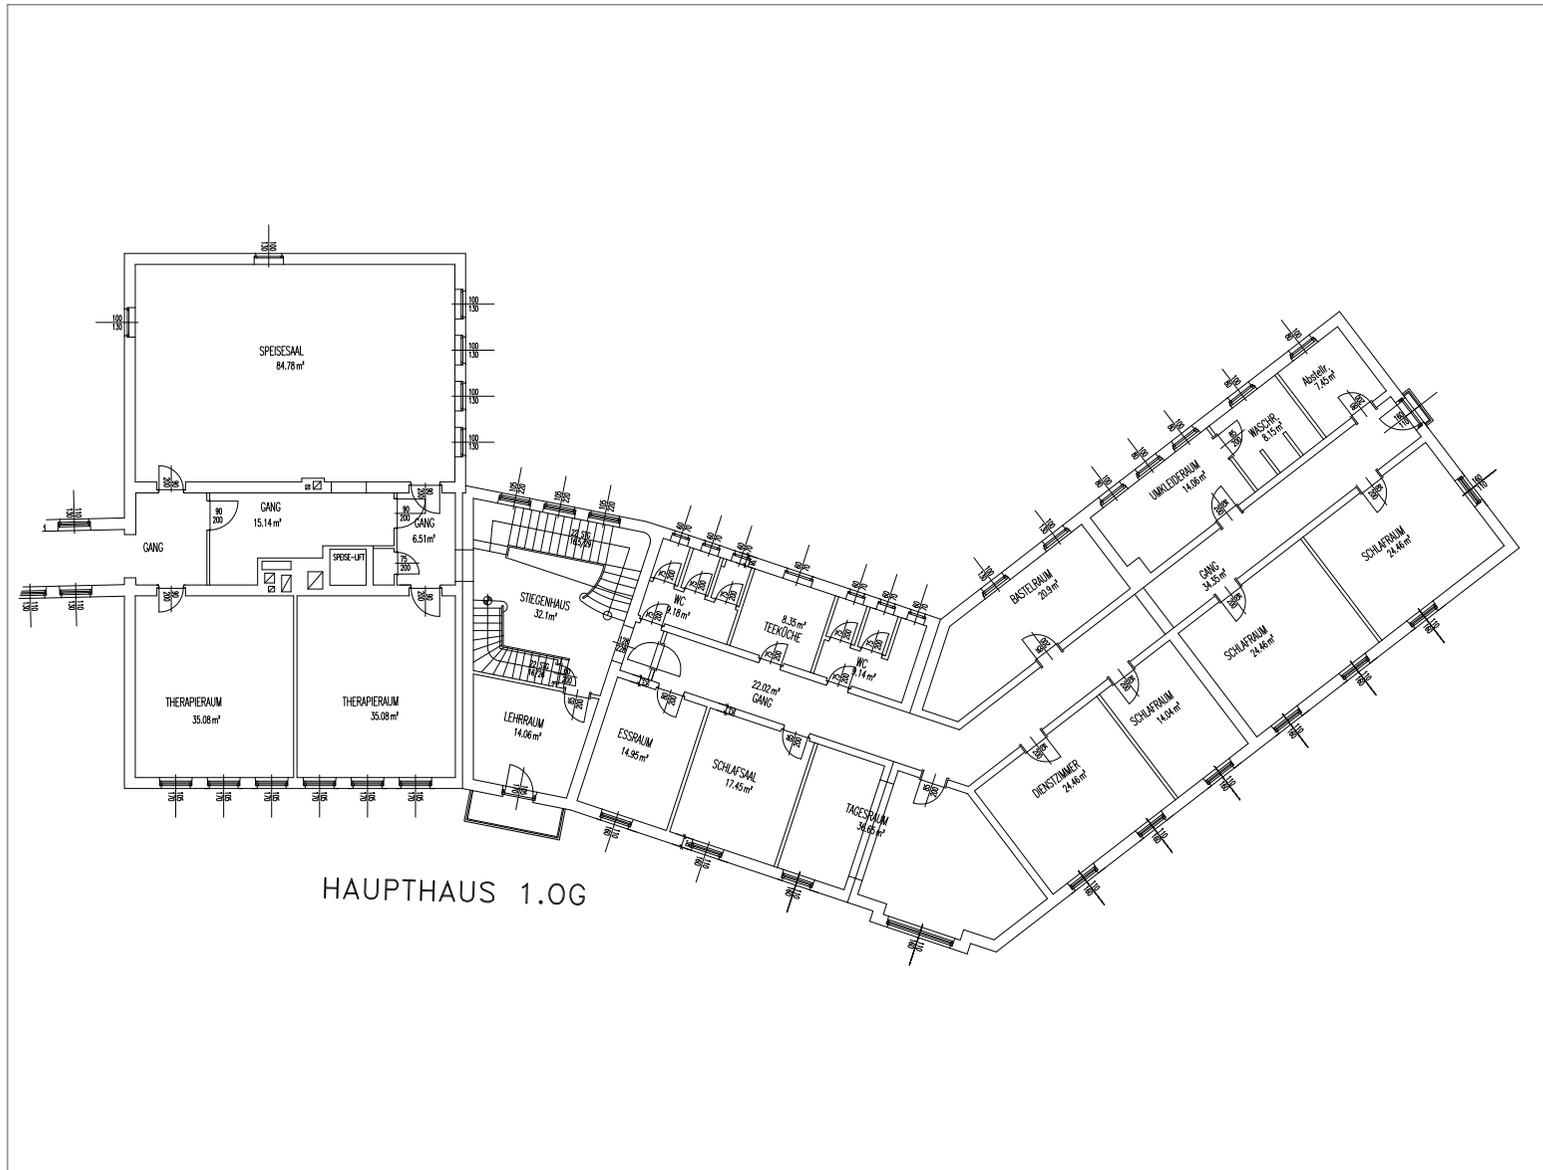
Grundriss des OGs des Haupthauses, ehemaliges LJH Rosenhof (Hartsleben 1999)
